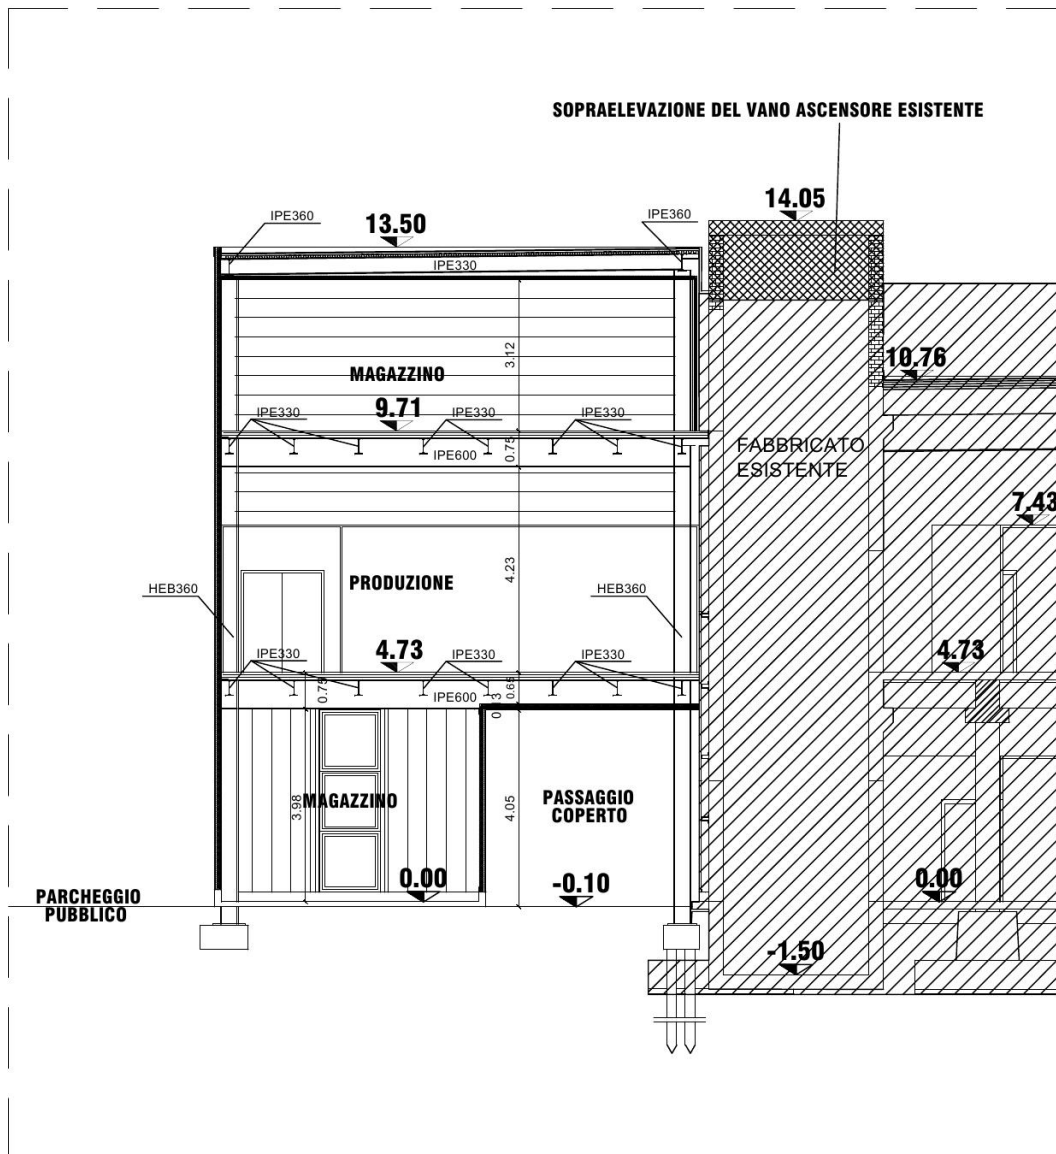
Particolare di A.2006.a.us.T01 - Progetto architettonico - Sezione trasversale tipo
